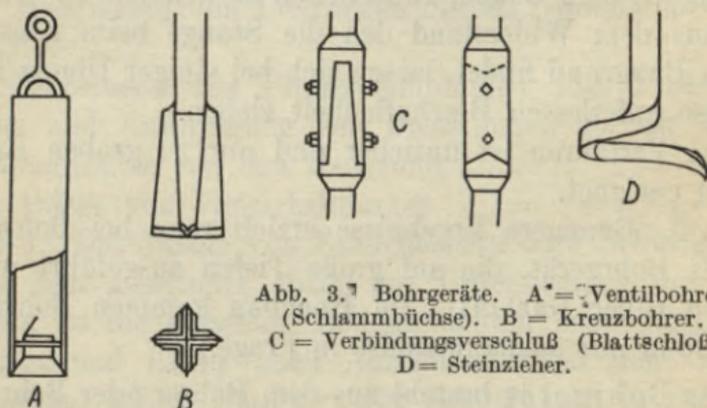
Bohrgeräte. A = Ventilbohrer (Schlammbüchse). B = Kreuzbohrer. C = Verbindungsverschluß (Blattschloß). D = Steinzieher.
